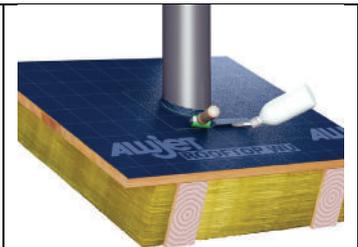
Ausführung verschweißen an Durchdringung
